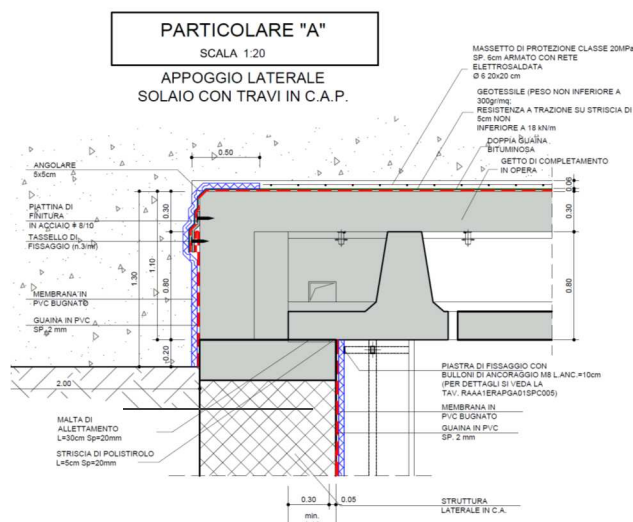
Particolare impermeabilizzazione risolto su travi prefabbricate (Sezione fra diaframmi)
